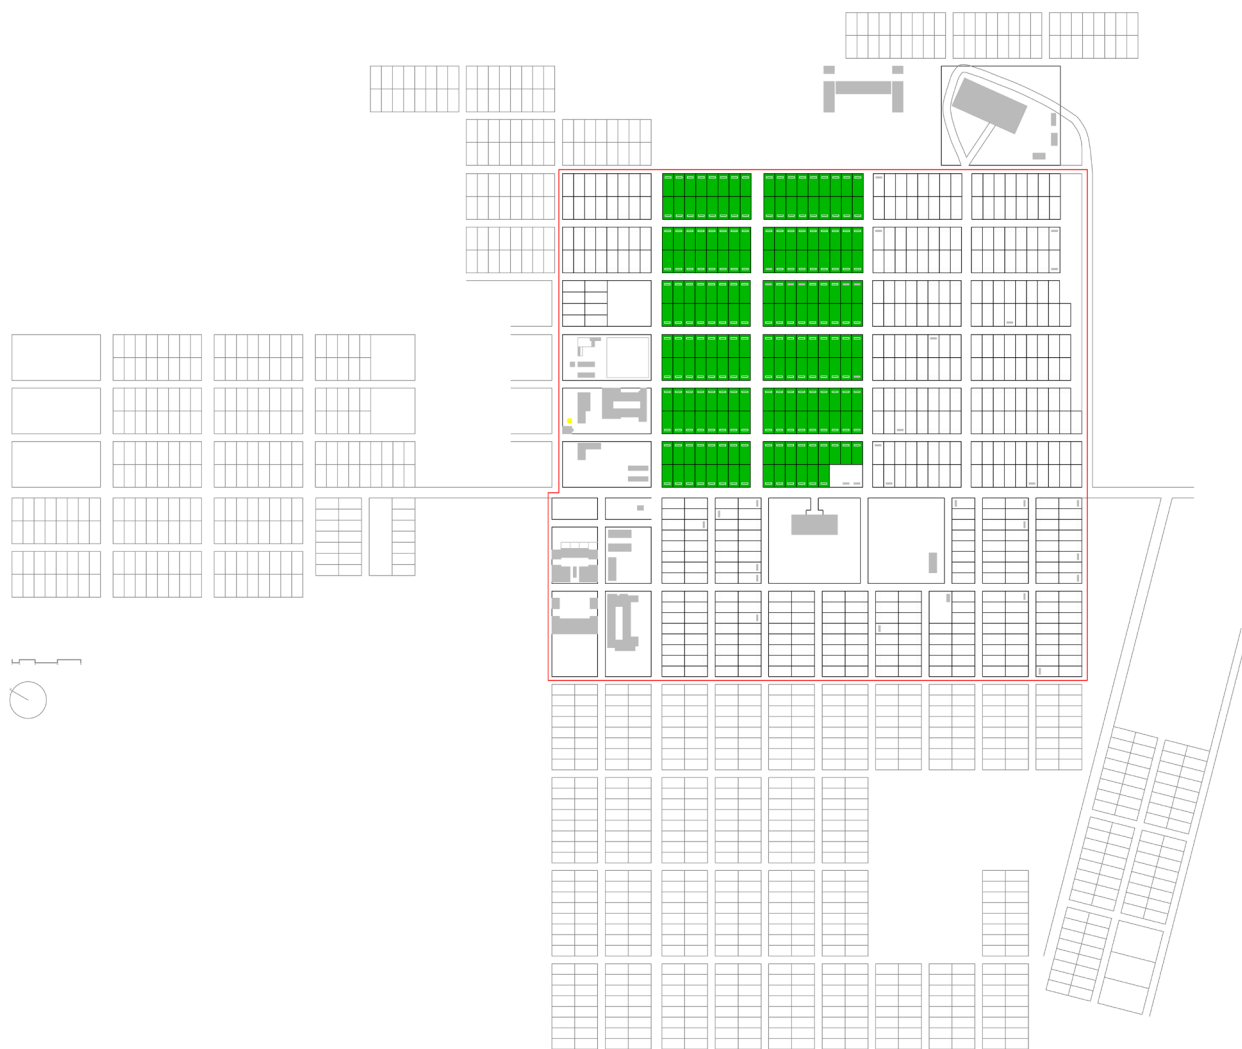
Planta do Bairro, primeiro período de construção da primeira fase, 2001. (ver em anexo planta com legendas e outras fases).
